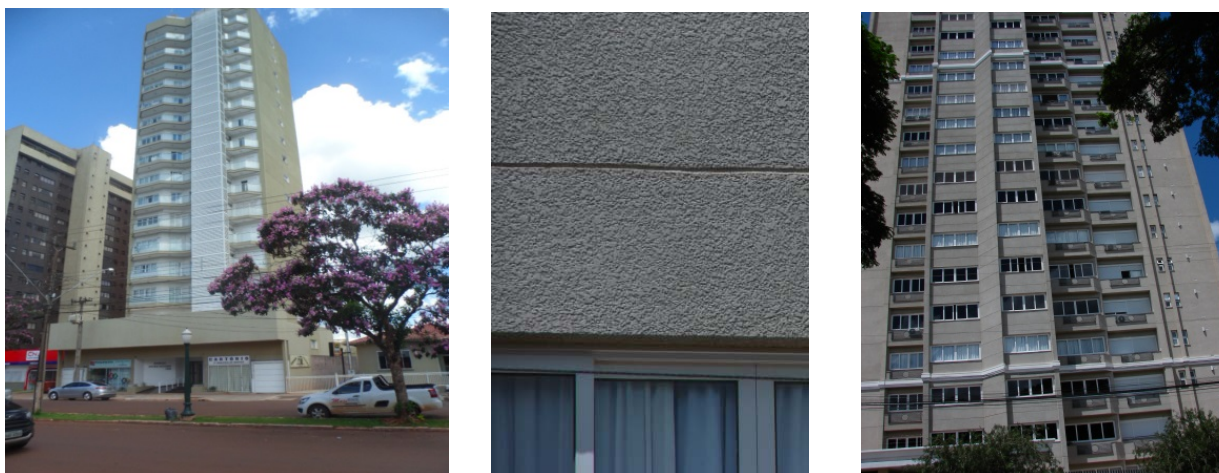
Edifícios A e B após a recuperação e detalhe do tratamento de superfície com textura projetada e as juntas de movimentação.
